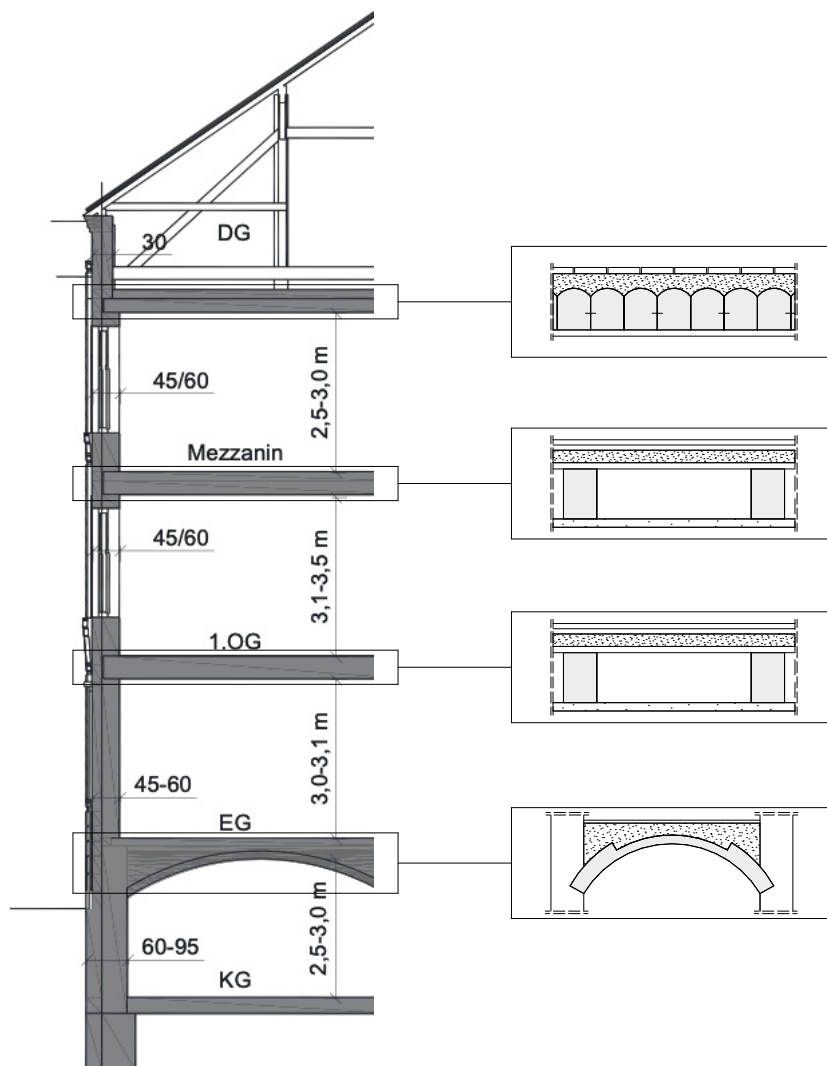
Schnitt durch ein typisches Gründerzeitgebäude (aus [22]) mit den üblichen Deckenarten (von oben nach unten: Dippelbaumdecke, Tramdecke, Tramdecke, Gewölbedecke)
